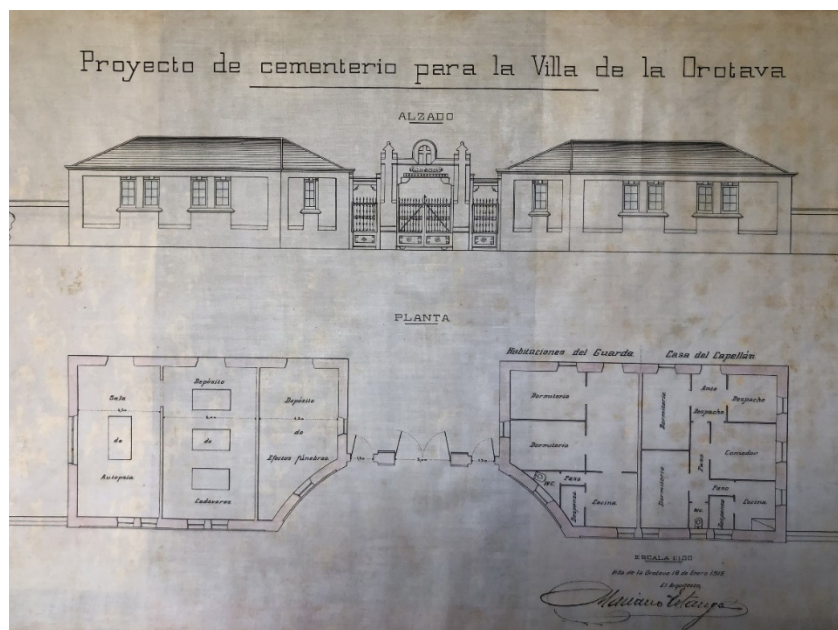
Mariano Estanga: *Proyecto de cementerio para la Villa de La Orotava. Alzado y planta.* Foto del autor.
